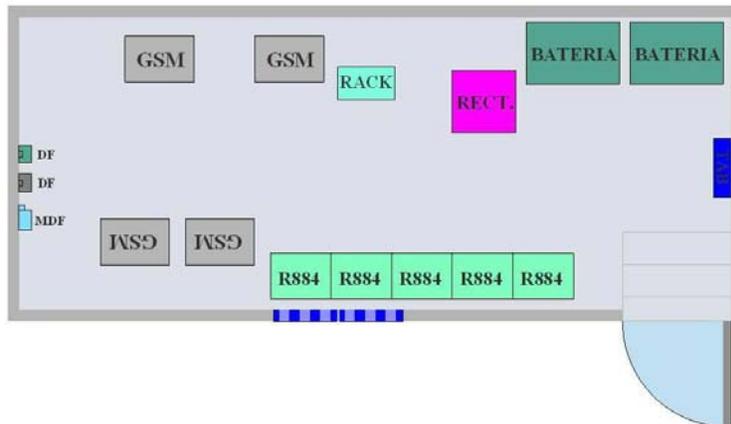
Plano de planta de contenedor Básico de Telcel.
